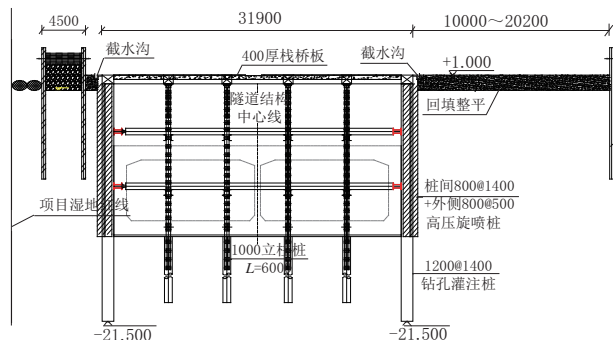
穿湖段深基坑结构典型剖面图(单位:mm)
